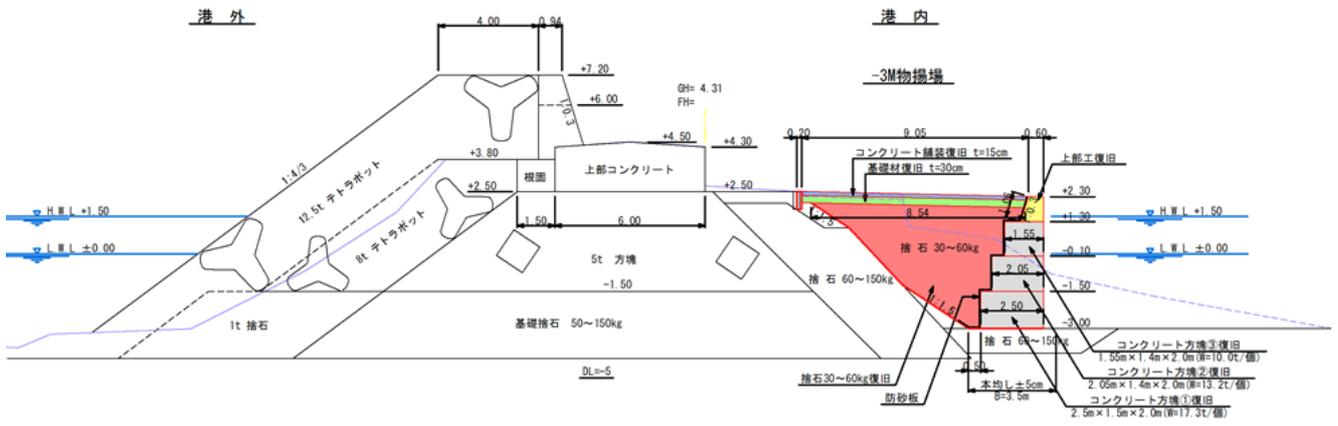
263 No.25 大洗港区_第1埠頭地区 A 物揚場 (-3m) の断面図 (復旧後)
